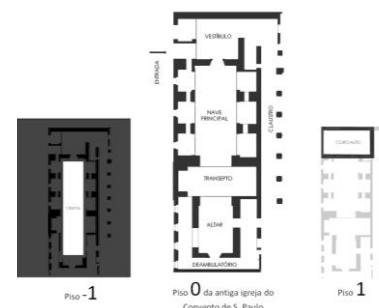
Plantas esquemáticas da antiga igreja do Convento S. Paulo
